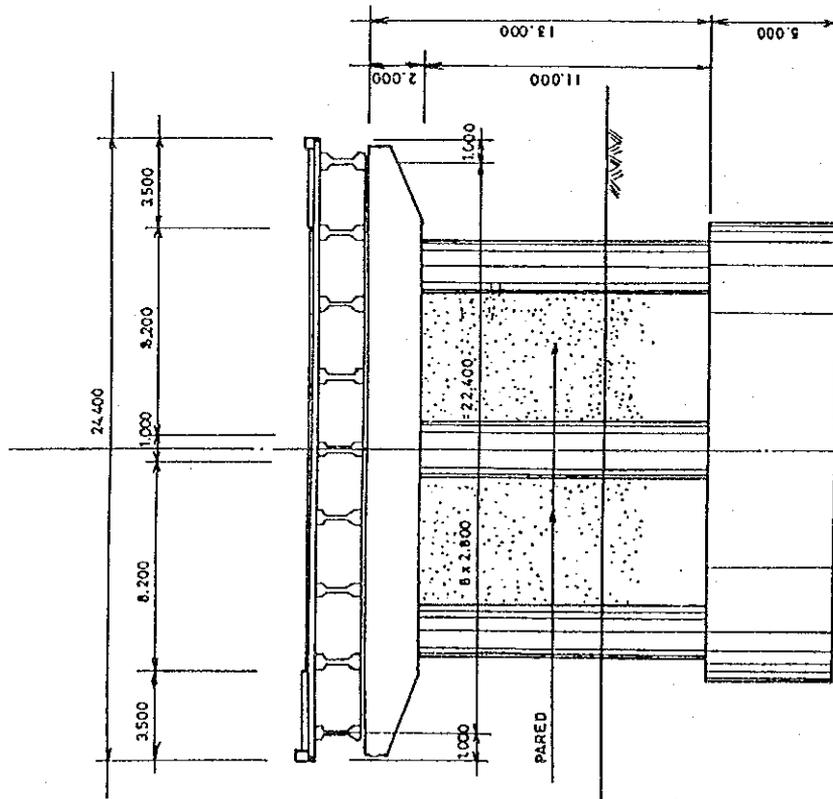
Puente de Vigas Implemente Apoyadas,
